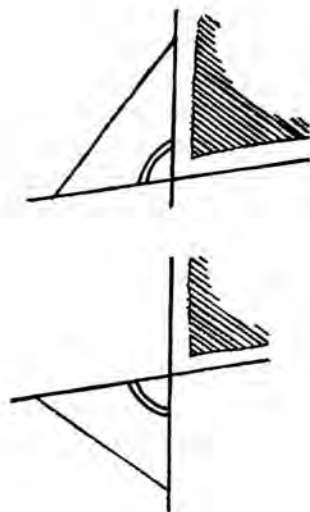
Фиксация наружного угла здания с помощью измерения смежного или накрест лежащего угла
